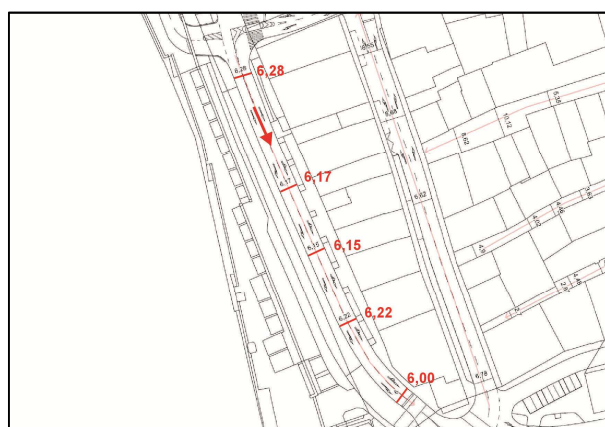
Kranenkai (zwischen Pleichertorstraße und Gerberstraße/Juliuspromenade) - Lageplan
